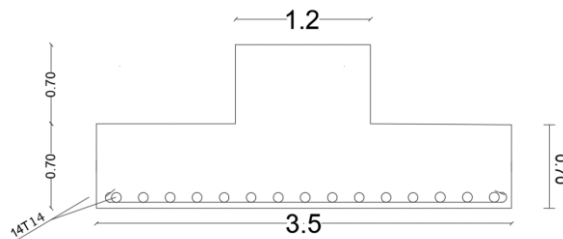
ferrailage de la semelle sous poteau selon le sens y-y
